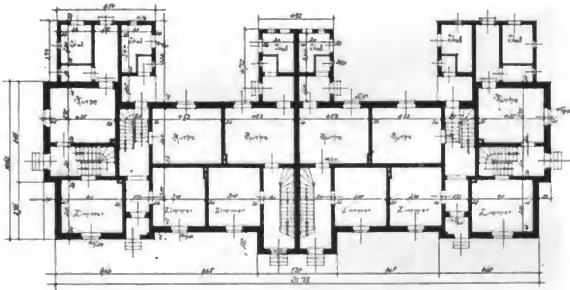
Grundriß zu Abb. 101. Erdgeschoß.
